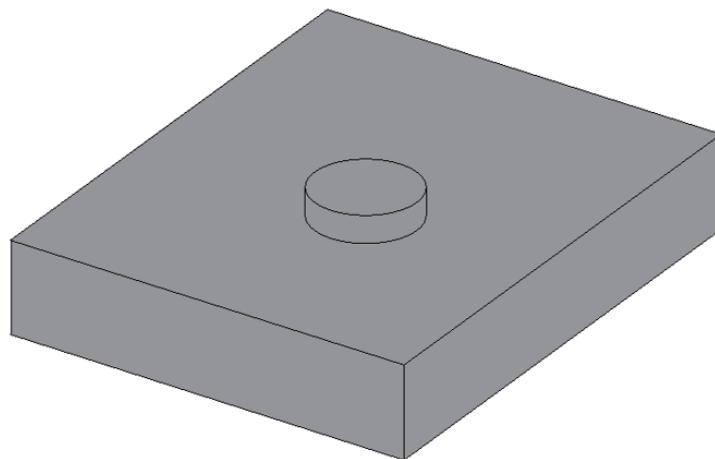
Croquis de la alternativa 3: zapata cuadrada. Fuente: Elaboración propia.
